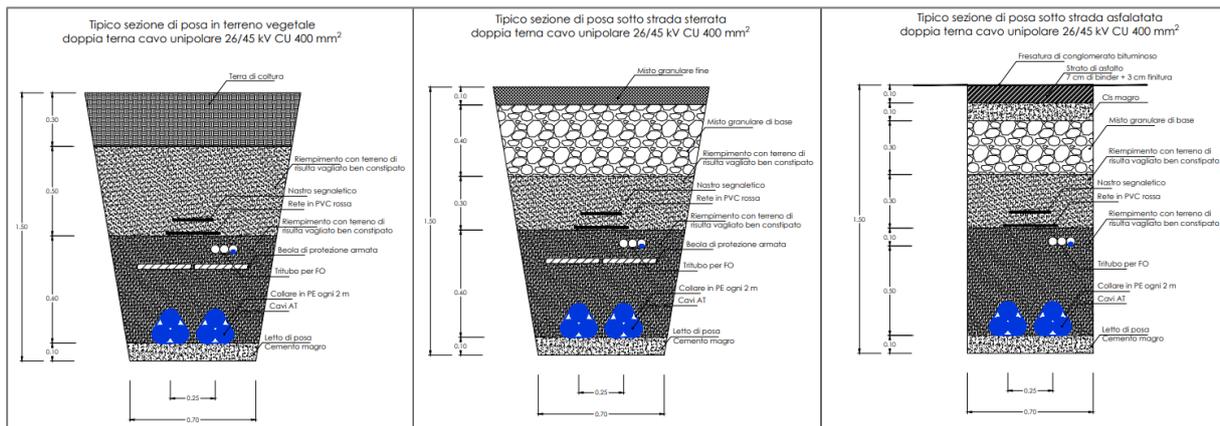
Modalità di posa cavidotto a 36 kV su terreno, strada in terra battuta e asfaltata
